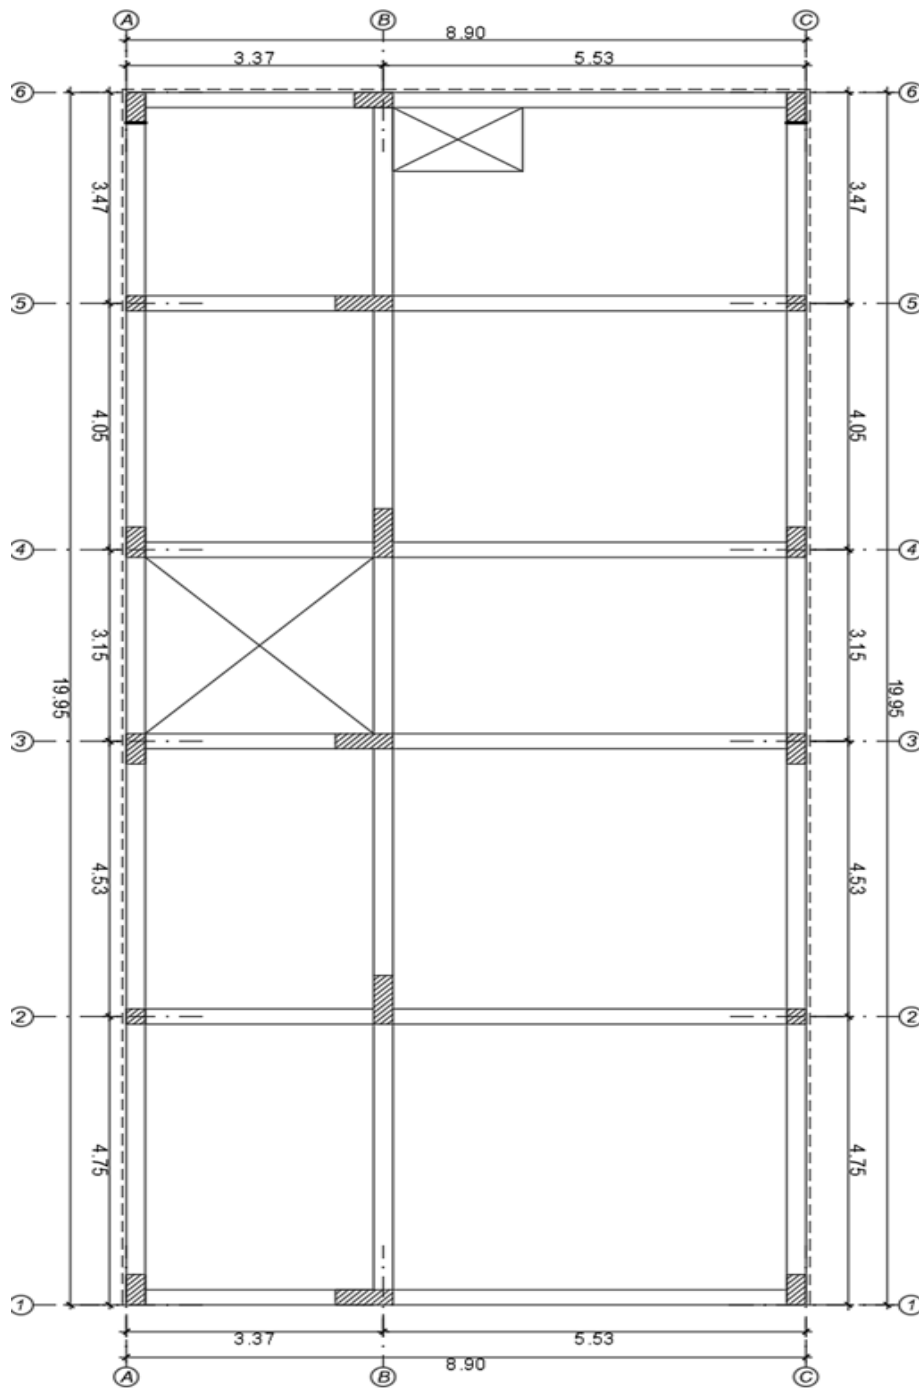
Distribución de vigas y columnas de estructura existente para gimnasio
